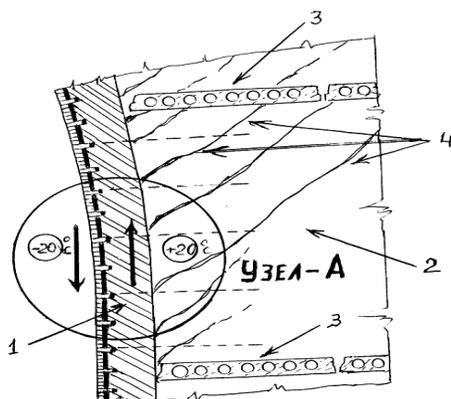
«Работа температурных ножниц»: 1 – самонесущая, многослойная торцевая стена системы К-69; 2 – несущая продольная стена; 3 – сборные ж/б плиты перекрытия; 4 – косые деформационные трещины.
